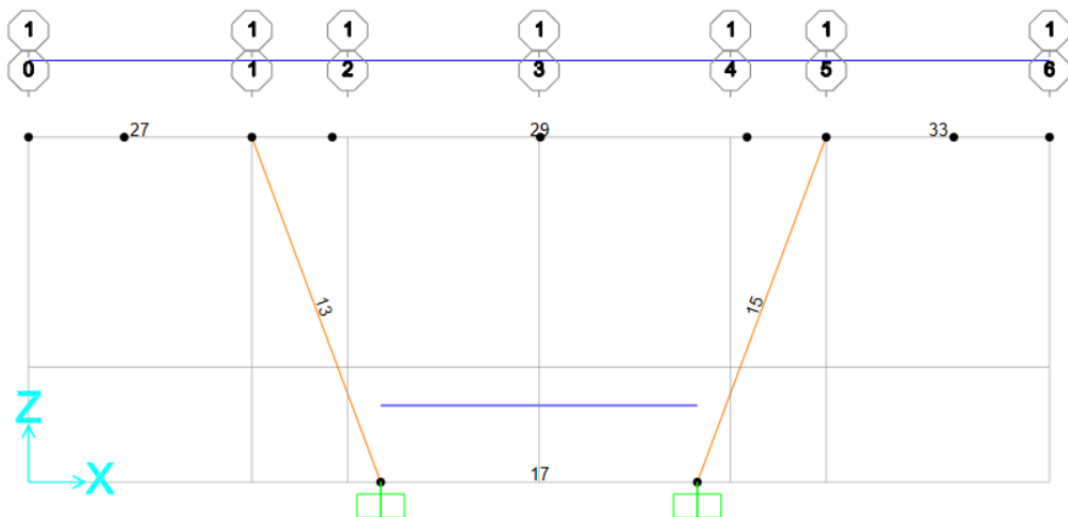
Modelado en SAP 2000 para pila #2. Fuente: Elaboración propia de autor.
